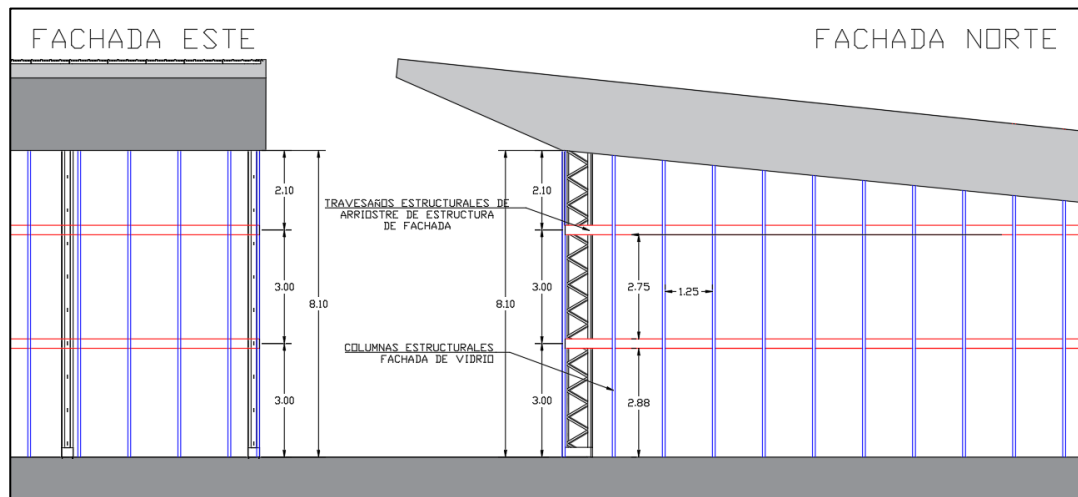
Detalle de la estructura de cerramiento de vidrio
